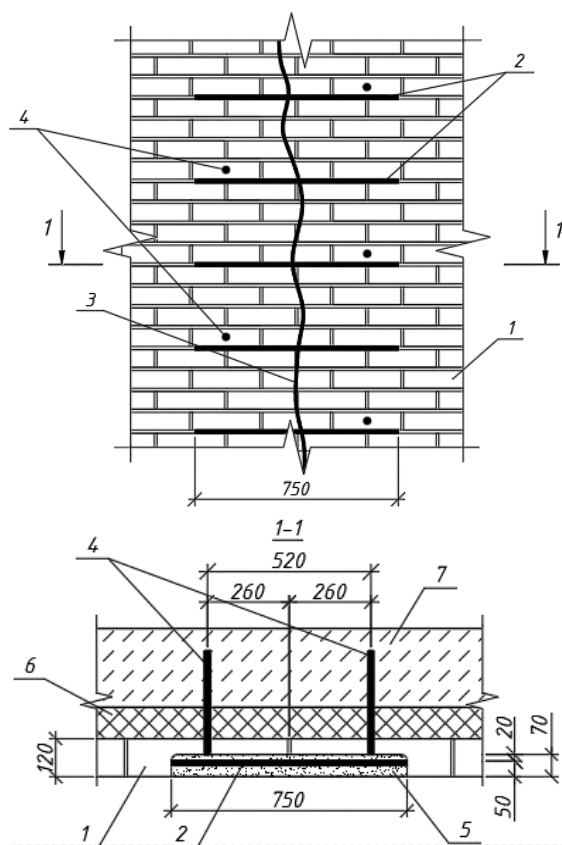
Усиление облицовочного слоя кладки в трехслойных стенах:
